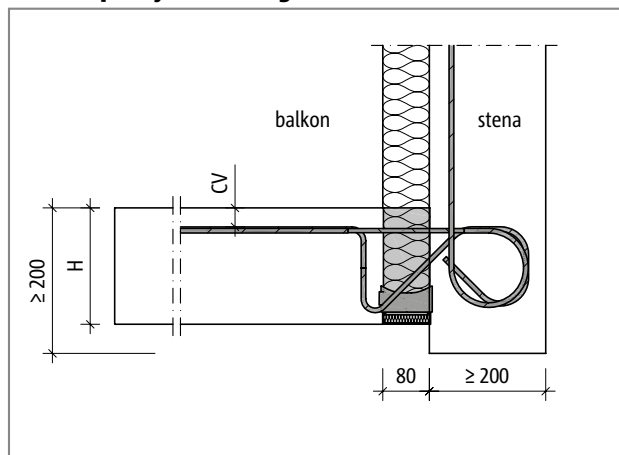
Schöck Isokorb® tip K-HV: nižje ležeči balkon in zunanja izolacija
